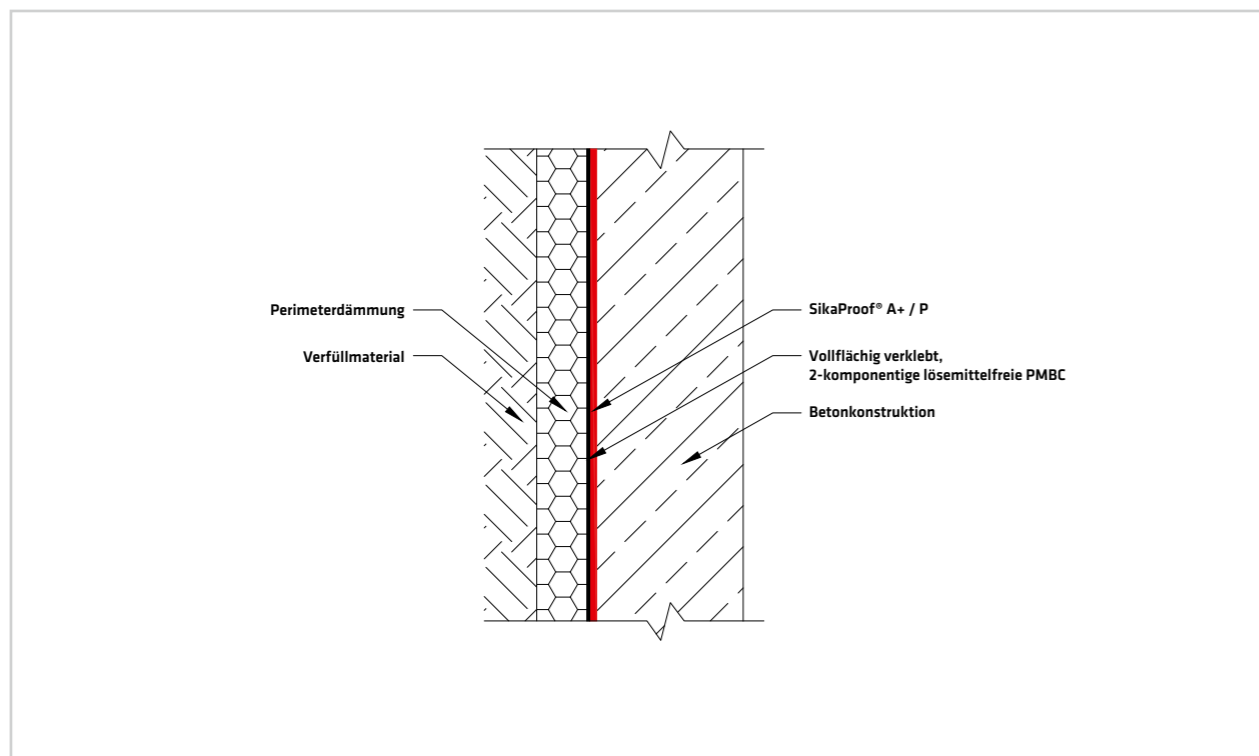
Zweihäufig geschalte Wand mit Anfüllschutz
